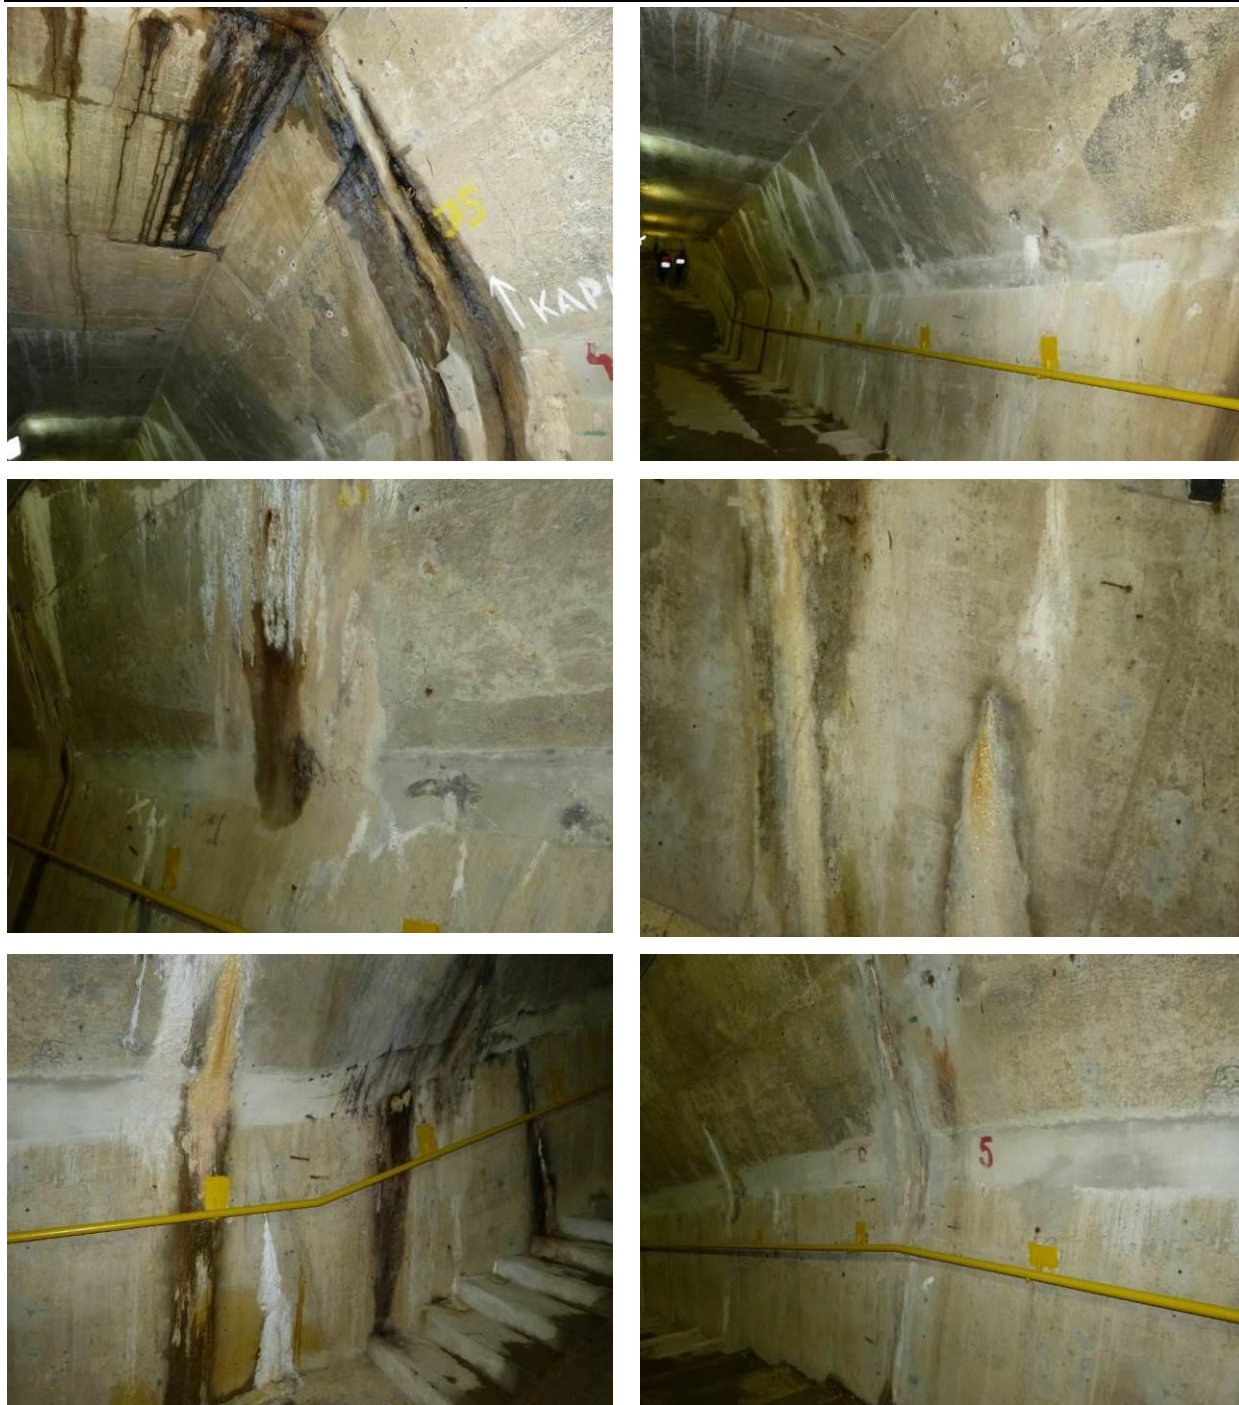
Widok na stan techniczny sekcji nr 3 konstrukcji galerii kontrolno-zastrzykowej
